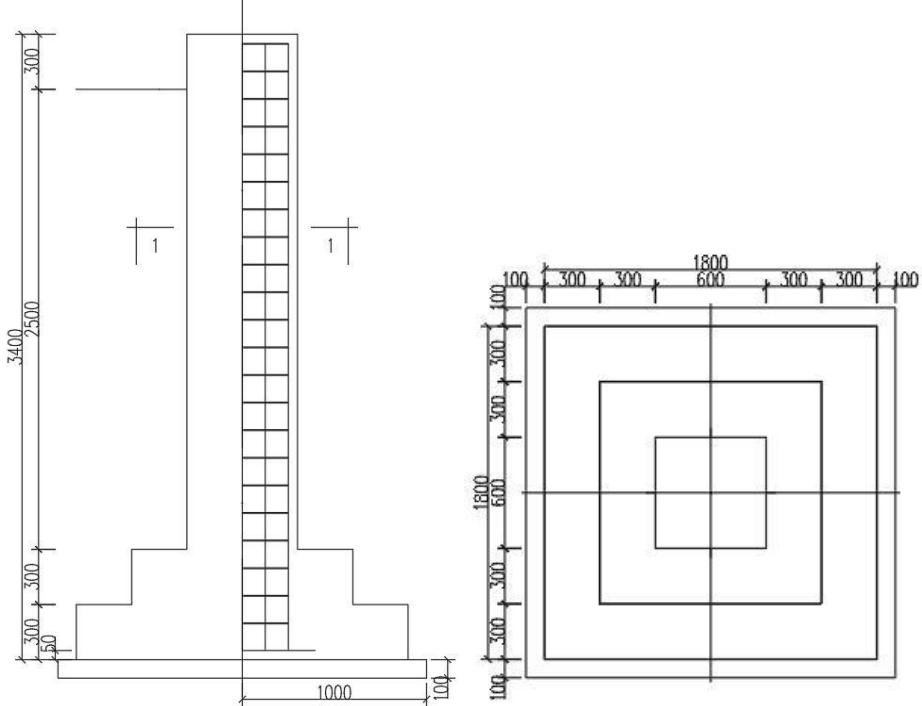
直线塔基础型式图 (尺寸单位: mm)
